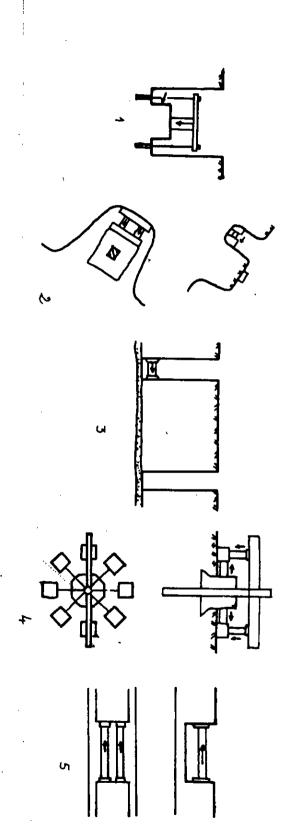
Essai de cissaillement dans les ouvrages souterrains
